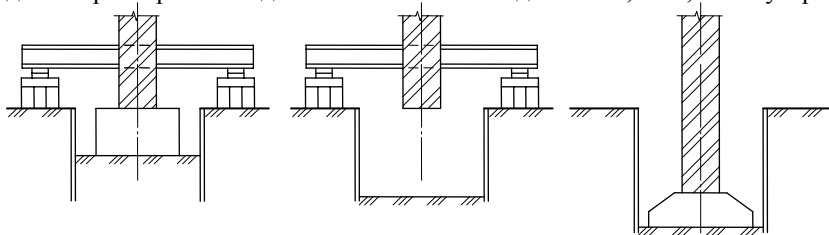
Переустройство ленточного фундамента с разборкой старой кладки фундамента
